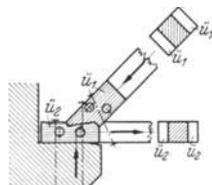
Versatz an einem Auflagerknotenpunkt unter Verwendung von Überhölzern (nach Kübler).
